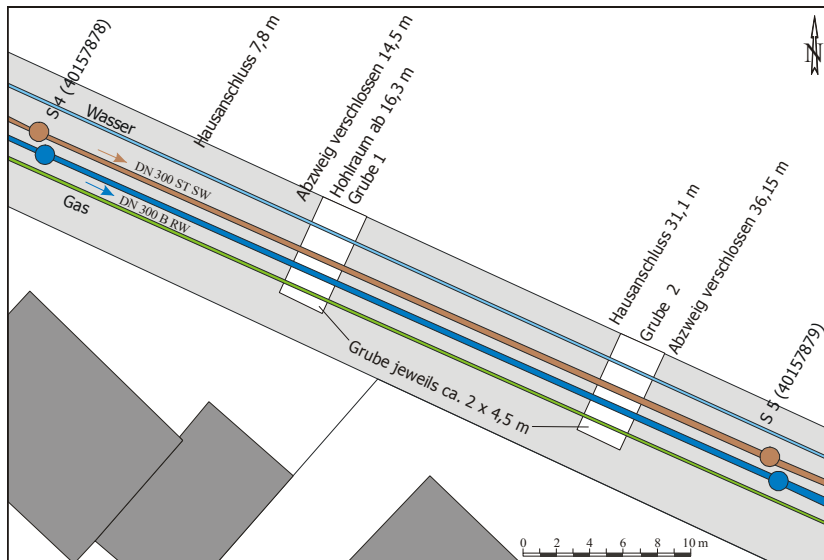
Detailausschnitt der Teststrecke Rastatt/Kastanienweg, Haltung von S 4 nach S 5 mit Lage der Baugruben, Hausanschlüsse, Abzweige und des eingebauten Hohlraums in Grube 1, Gas- und Wasserleitung, Schmutzwasserkanal (SW) DN 300 Steinzeug und Regenwasserkanal (RW) DN 500 Beton (nach EISWIRTH 2002).
